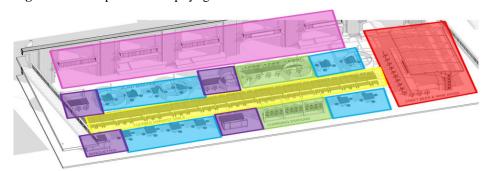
Planta Baixa do espaço gastronômico Forks Market.
